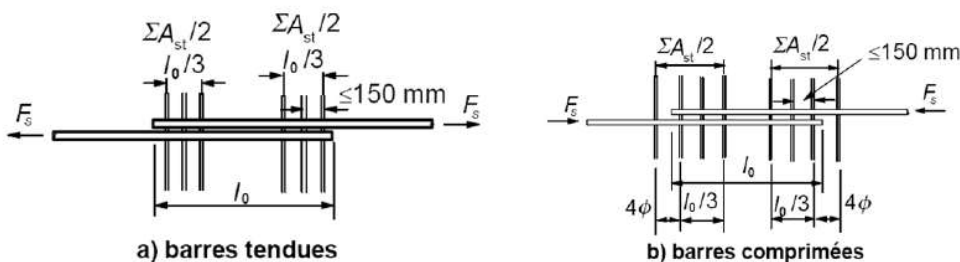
Disposition des armatures transversales dans les zones de recouvrement des barres
